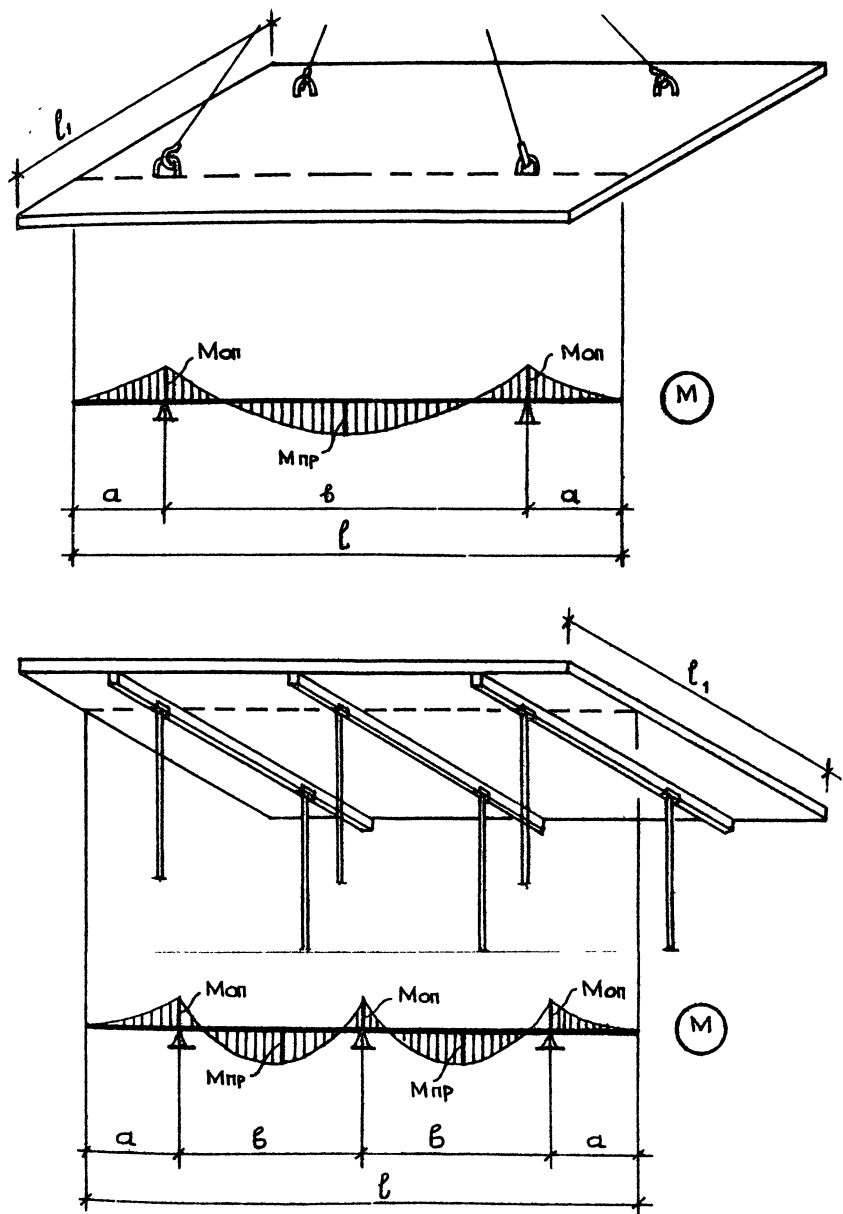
а. Эпюры моментов в плите-скорлупе при монтаже и бетонировании сборно-монолитного перекрытия
